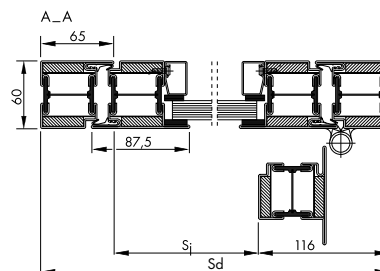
Coupe horizontale d'une porte coupe-feu à un battant EI 30.
